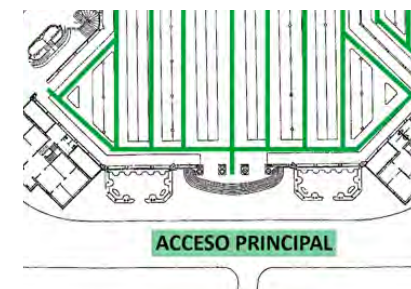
Plano detalle de la entrada principal por la plaza del Mercado
